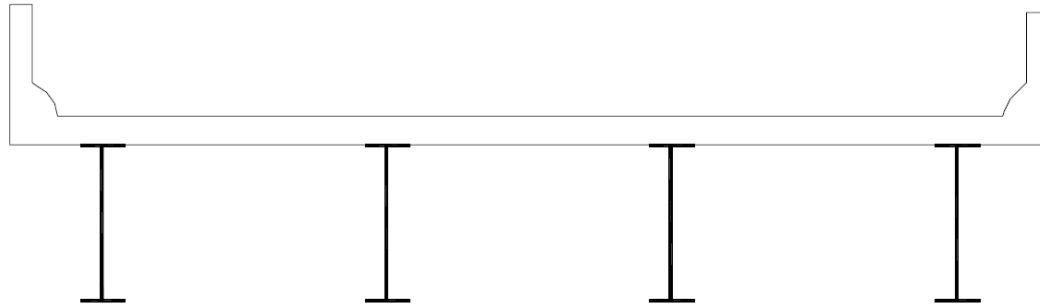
Sección transversal de puente con vigas de acero (AASHTO, 2007)
